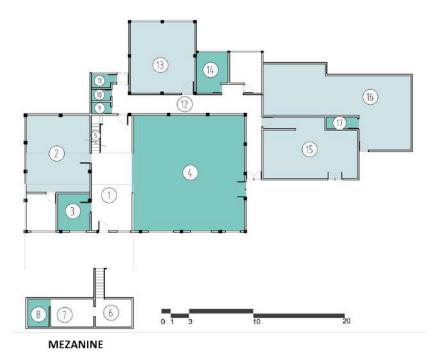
Planta 1 Bloque 34. Fuente: Equipo de diagnóstico.
